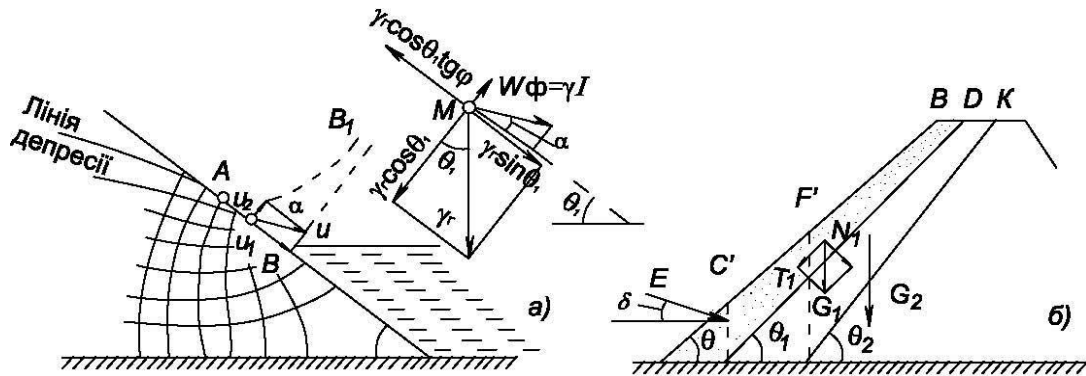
Схеми для розрахунку стійкості укосу на опливання (а) та ґрунтового екрана і захисного шару (б)
